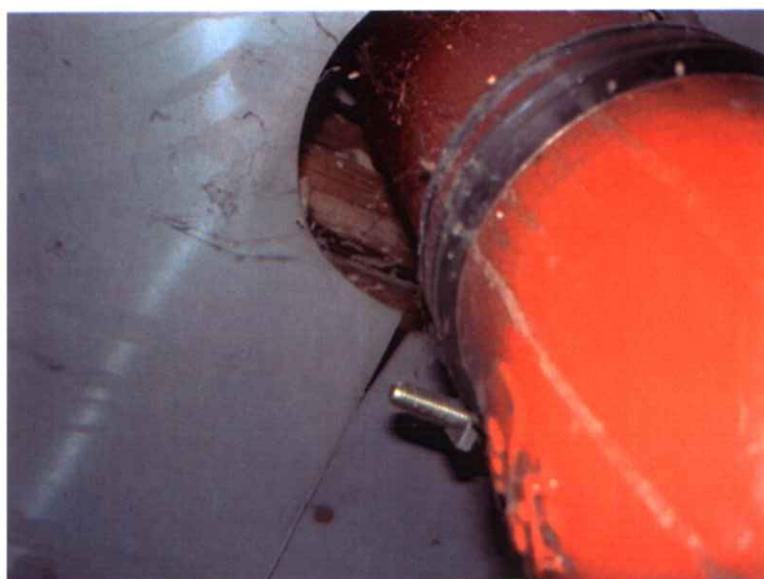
direkte adgang til trædæk ved gennemføring af faldstamme. Dette er ikke brandsikkert.
